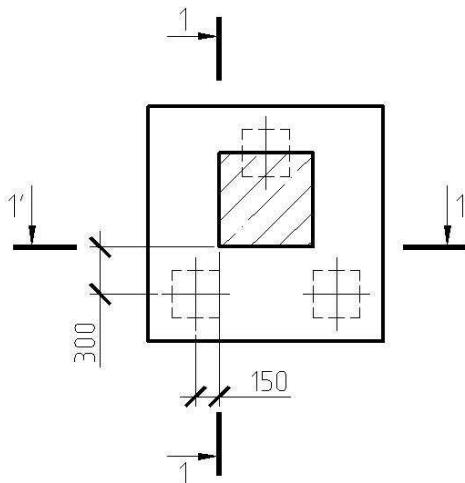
Схема к расчету ростверка на изгиб
